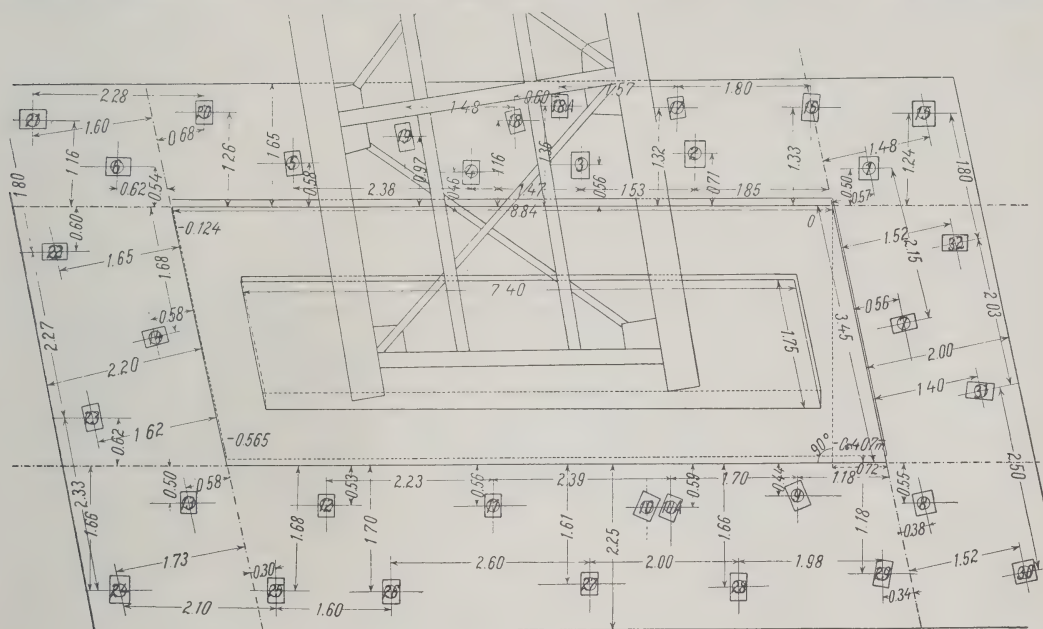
Grundriß des rekonstruierten Widerlagers der Marrioutbahn.
